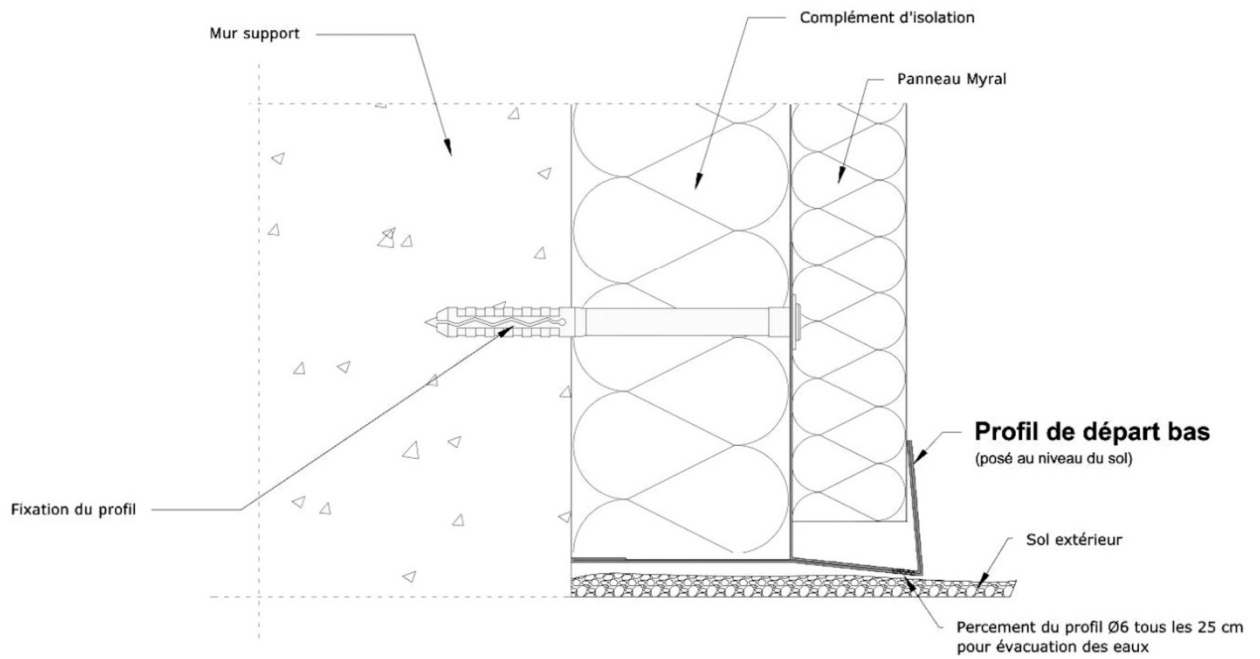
Bas de façade – Pose en vêtage (coupe verticale)
